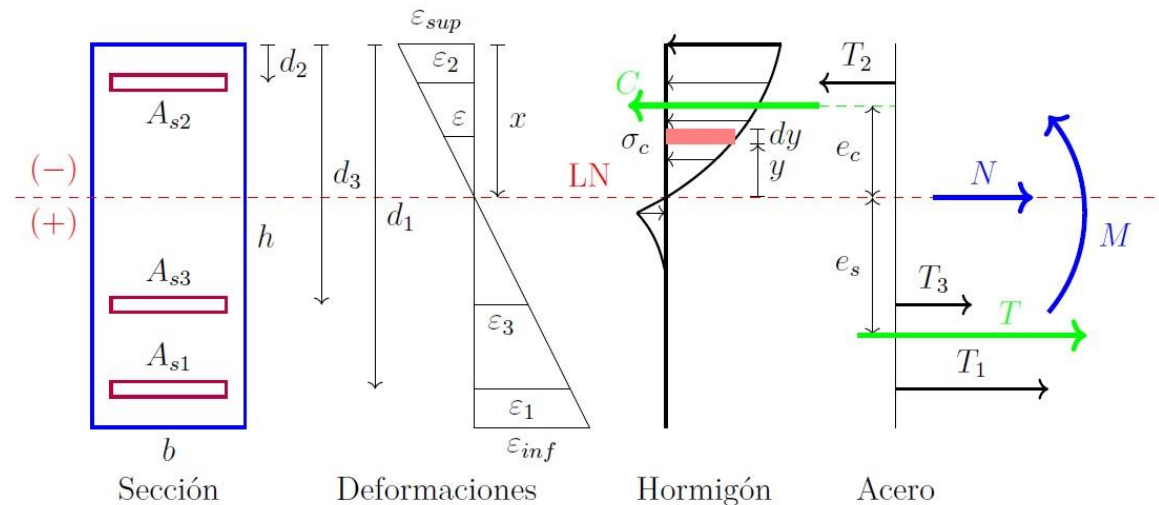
Comportamiento esquemático de una sección de hormigón armado. Fuente: Tesis de Maestría realizado por el Ing. Fredy Ramírez, San Lorenzo 2019.
